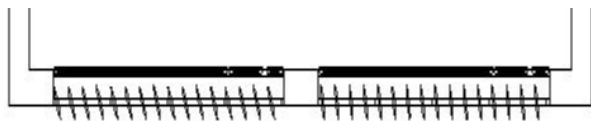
coupe horizontale sur le brise-soleil de 30 cm et orienté 10 degré
